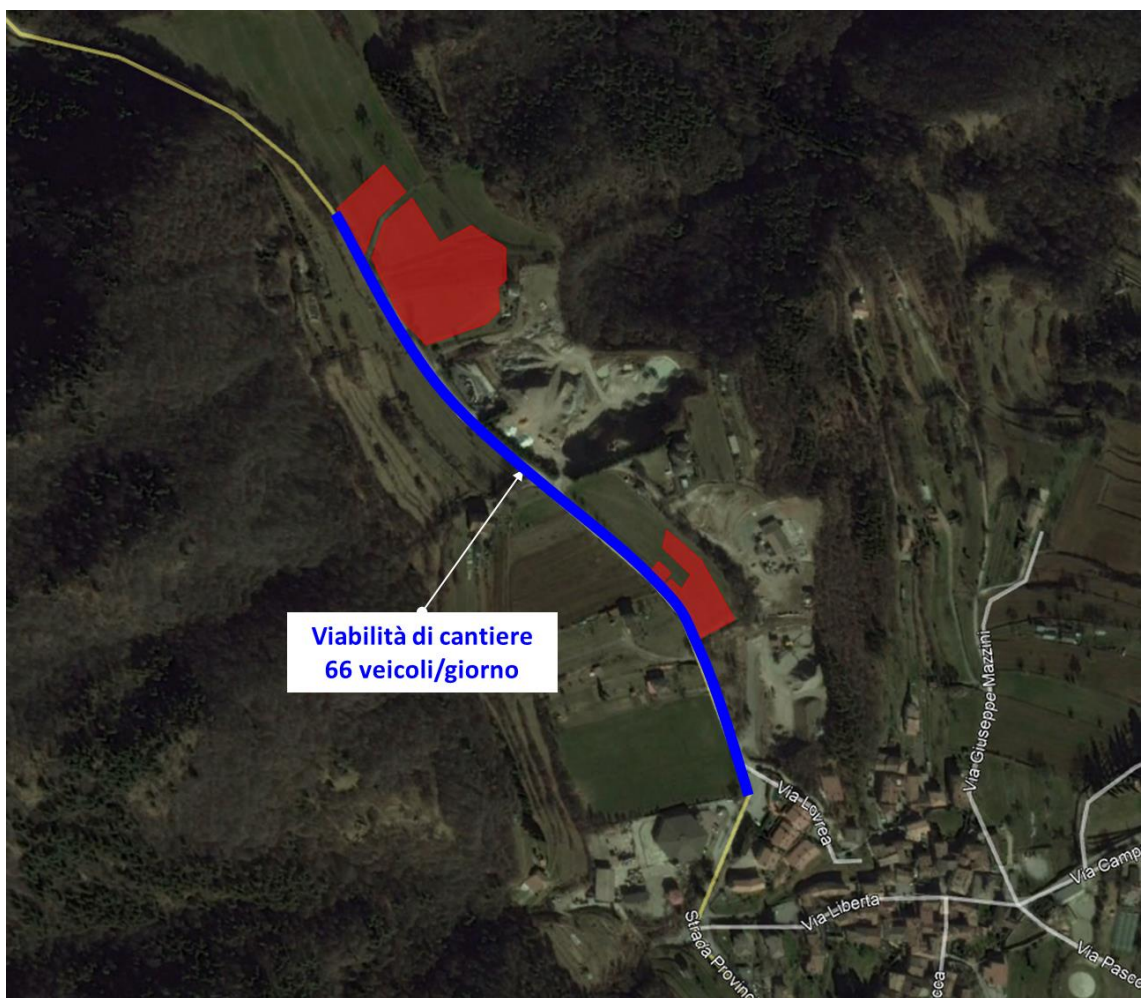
Rappresentazione viabilità di cantiere – Scenario1
